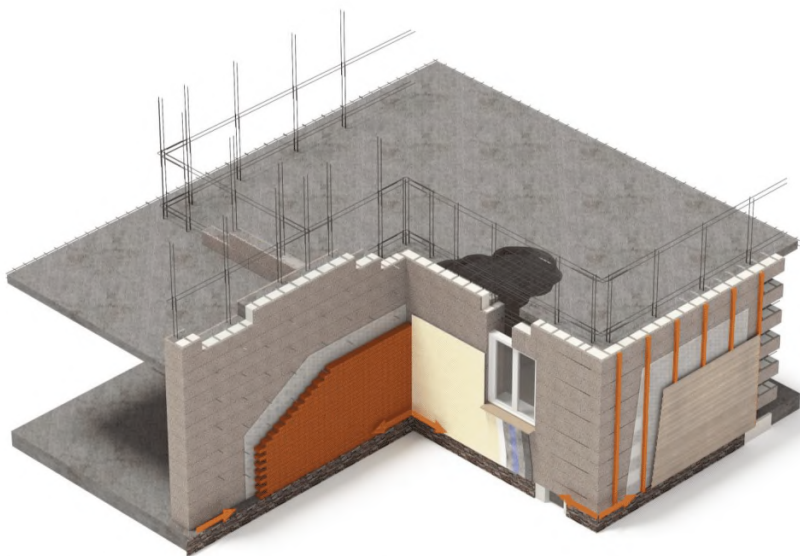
Различные варианты отделки фасада наружных стен здания из многопустотных вибропрессованных керамзитобетонных блоков
